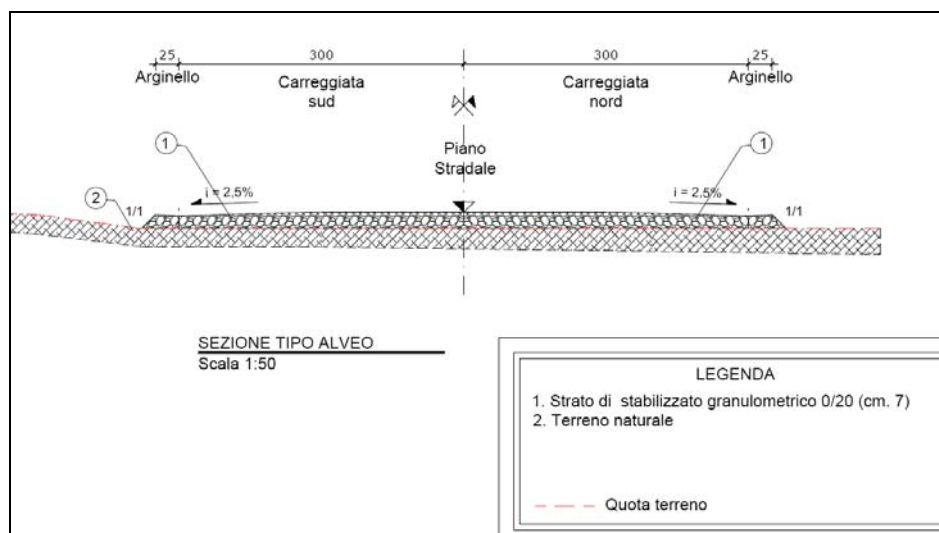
Sezione tipo pista di accesso principale. Tratto lungo alveo (dal 1° tratto demaniale all'accesso di cava).
